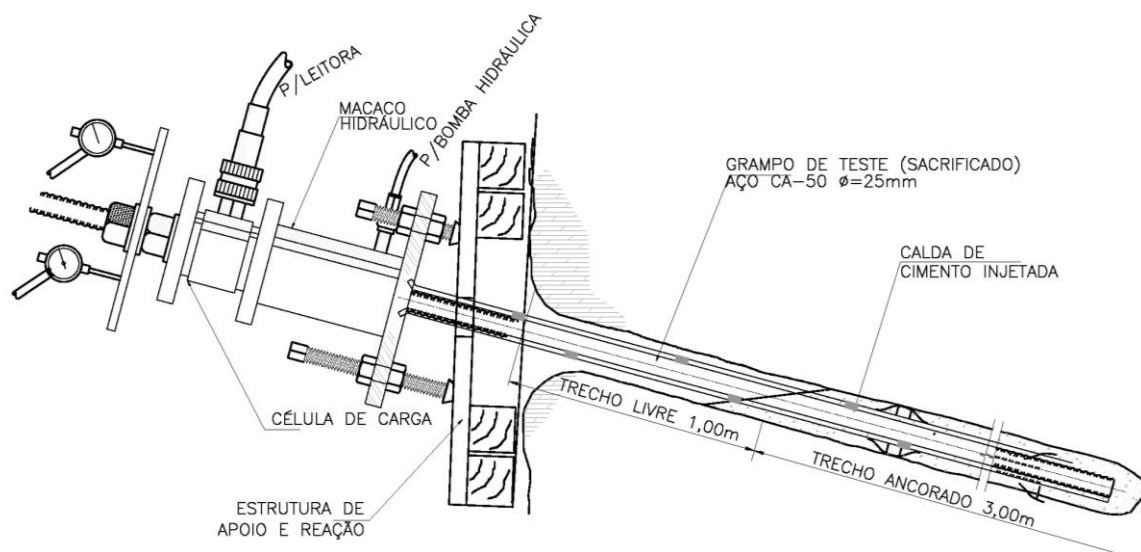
Croqui do arranjo do ensaio de arrancamento.
